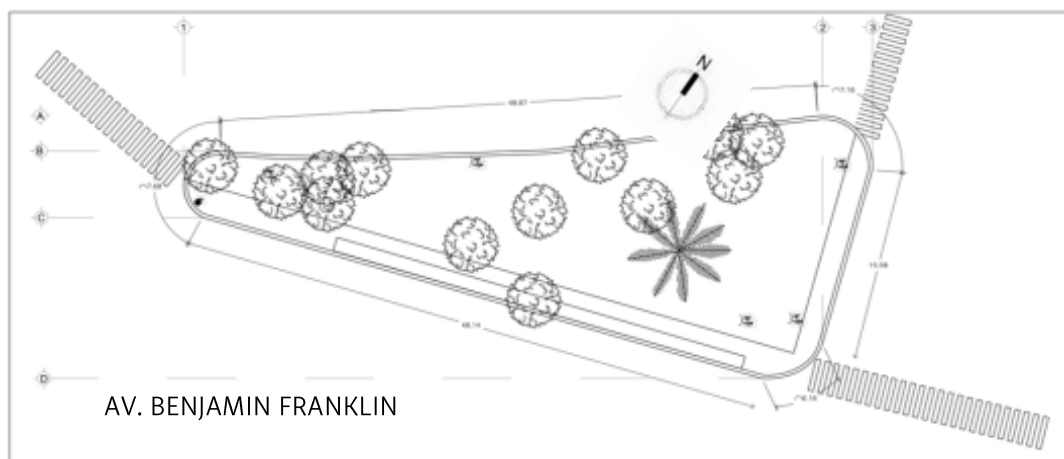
Planta de levantamiento del estado actual. Elaborado por Sophia Rodríguez Navarro.
